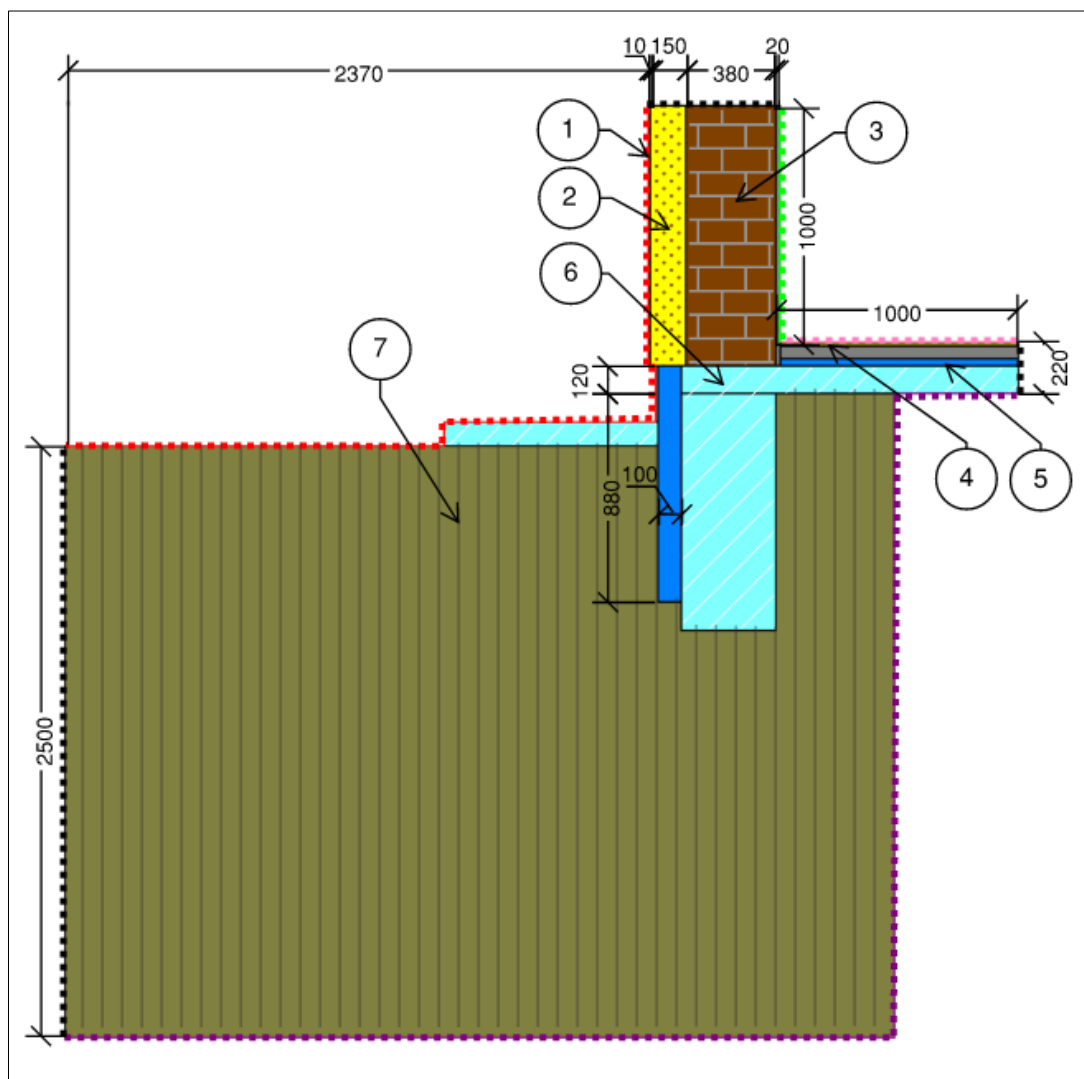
Схема базового вузла конструкції підлоги по ґрунту до зовнішніх стін з фасадною теплоізоляцією
